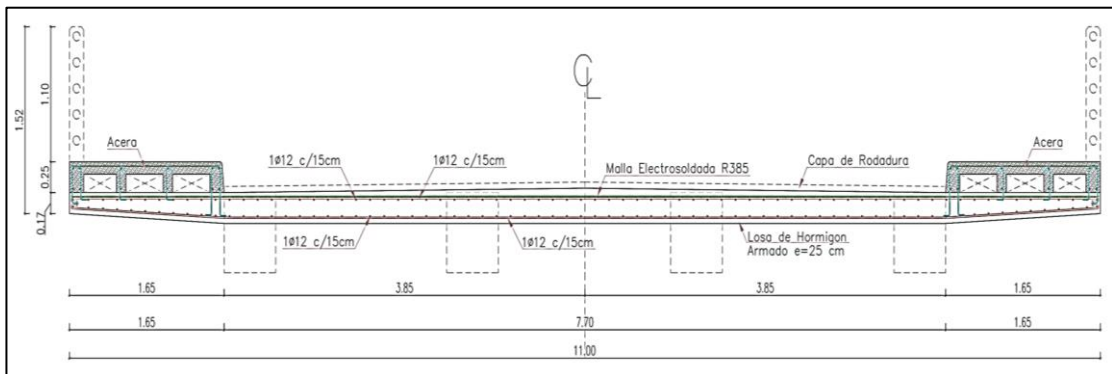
Sección de transversal de armado de la losa. Fuente: Autor
